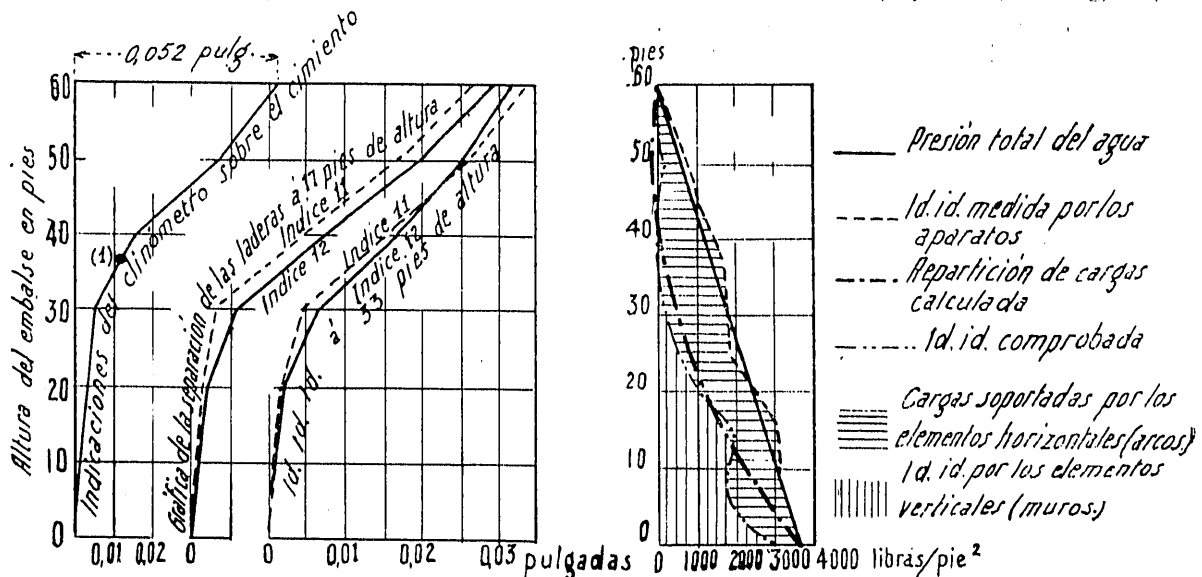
ª Agrietamiento del cemento, movimiento de las laderas y cargas observadas en la presa de Stevenson Creek. (1) Aparición de la grieta en el cemento.
